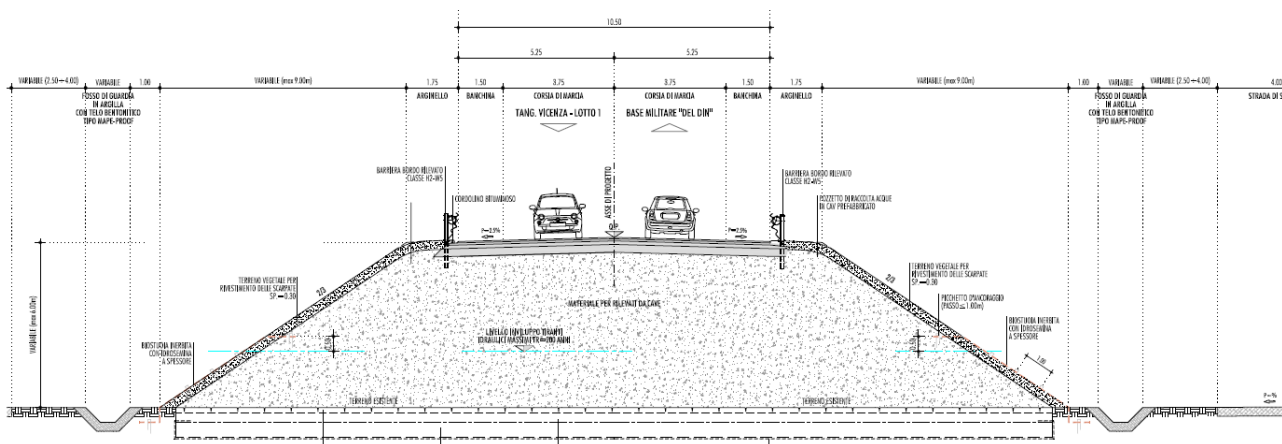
SEZIONE TIPO IN RILEVATO
